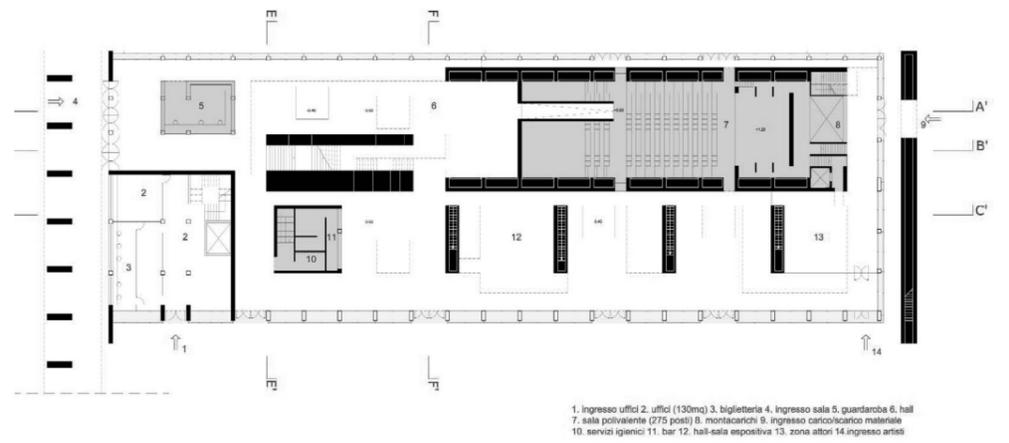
, pianta piano terra nuovo padiglione 1a. Progetto definitivo, disegno concesso dall'A. P.
